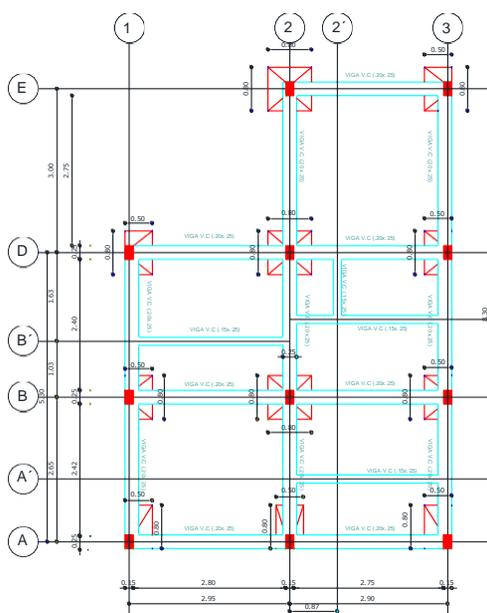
Planta general ejes, zapatas y estructura para vivienda de un piso, proyecto postulación de VIS
